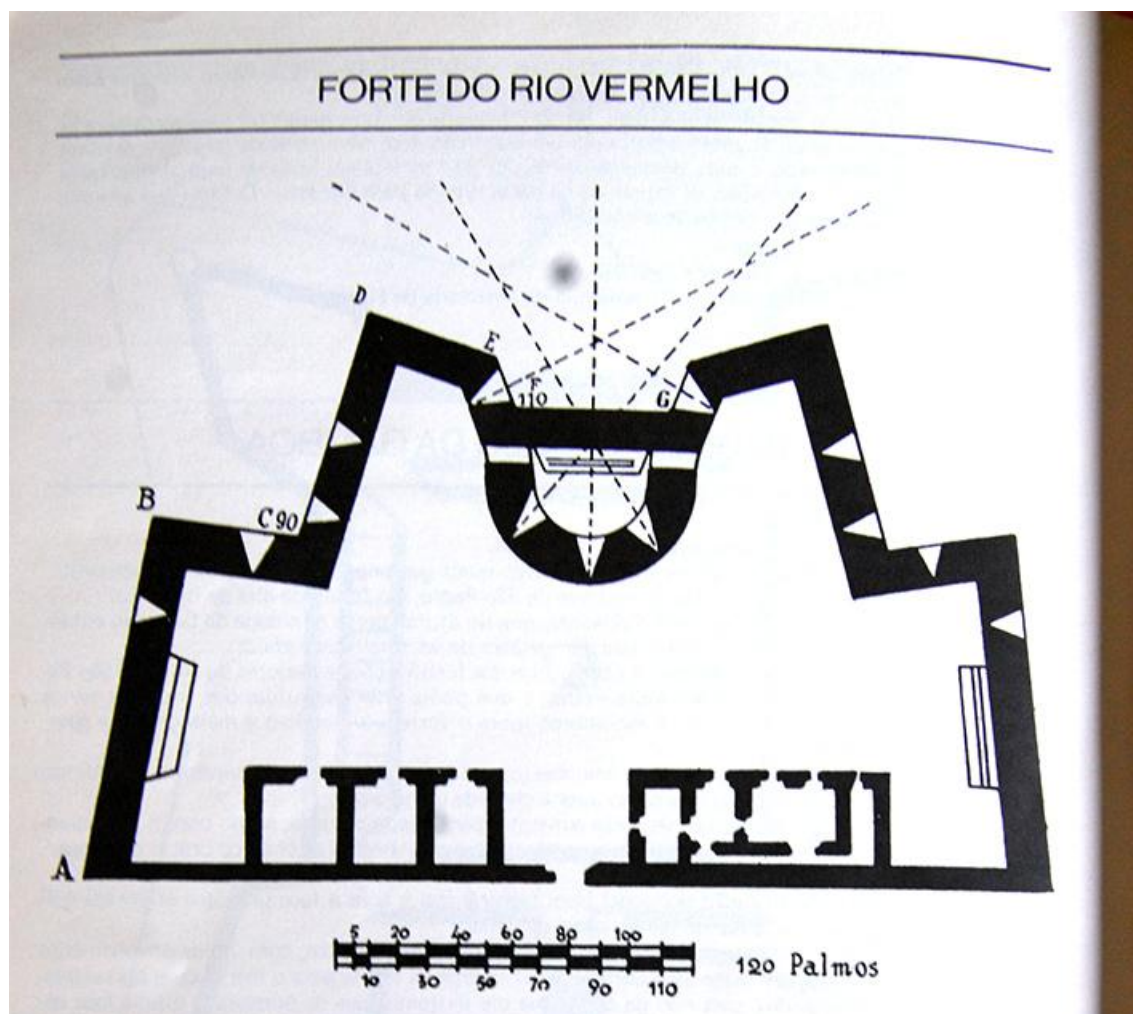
Planta do Forte Rio Vermelho, Bahia, cenário da primeira campanha do jogo.
